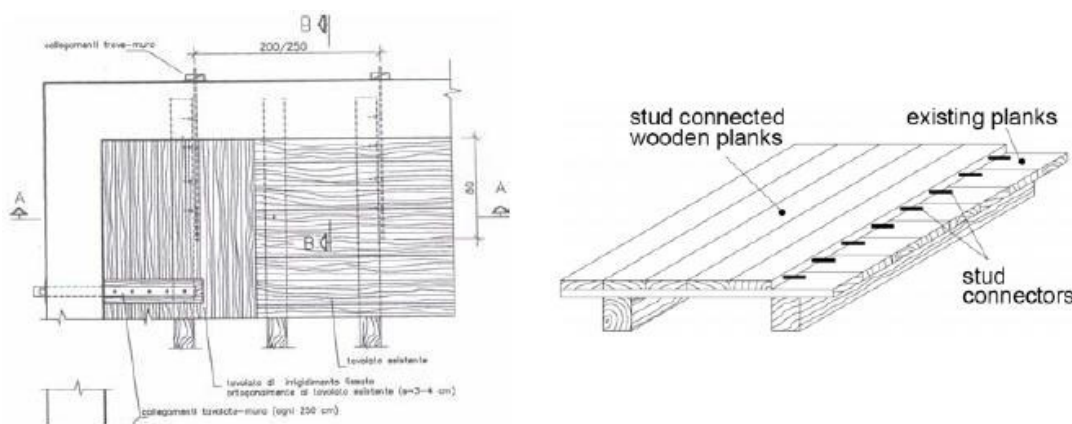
Aplicação de novo soalho e respectivas ligações das vigas às paredes (Lombardo et al.;1997) e à direita um esquema com utilização das peças metálicas horizontais (Marini et al.;2006).
